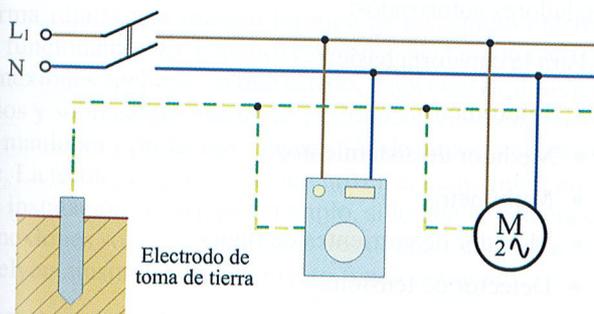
Puesta a tierra de las masas metálicas de los receptores.
